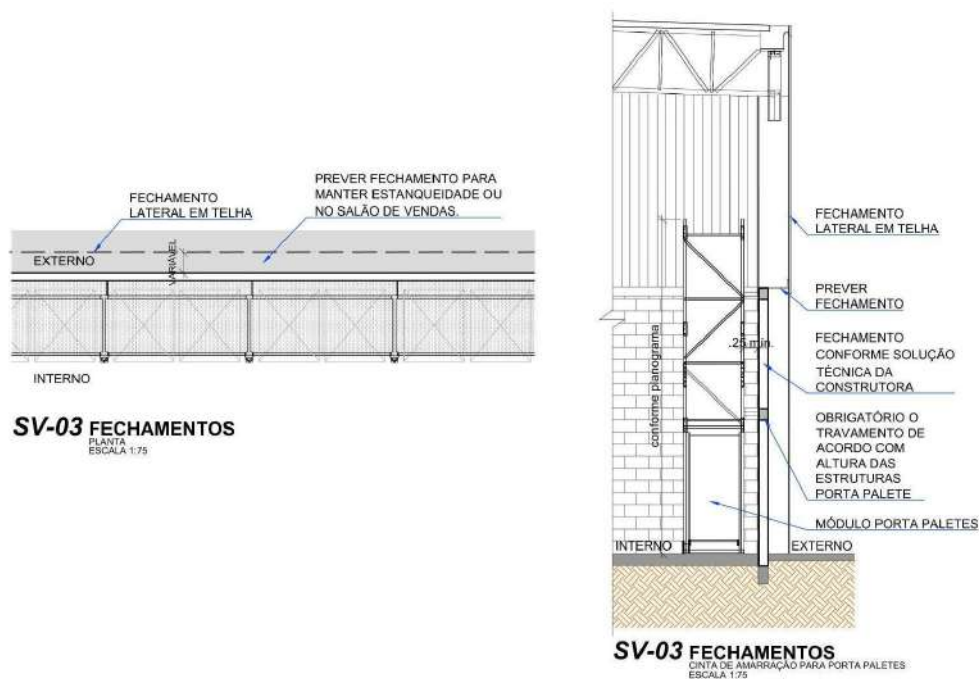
Sistema de fechamento híbrido do Salão de Vendas.
